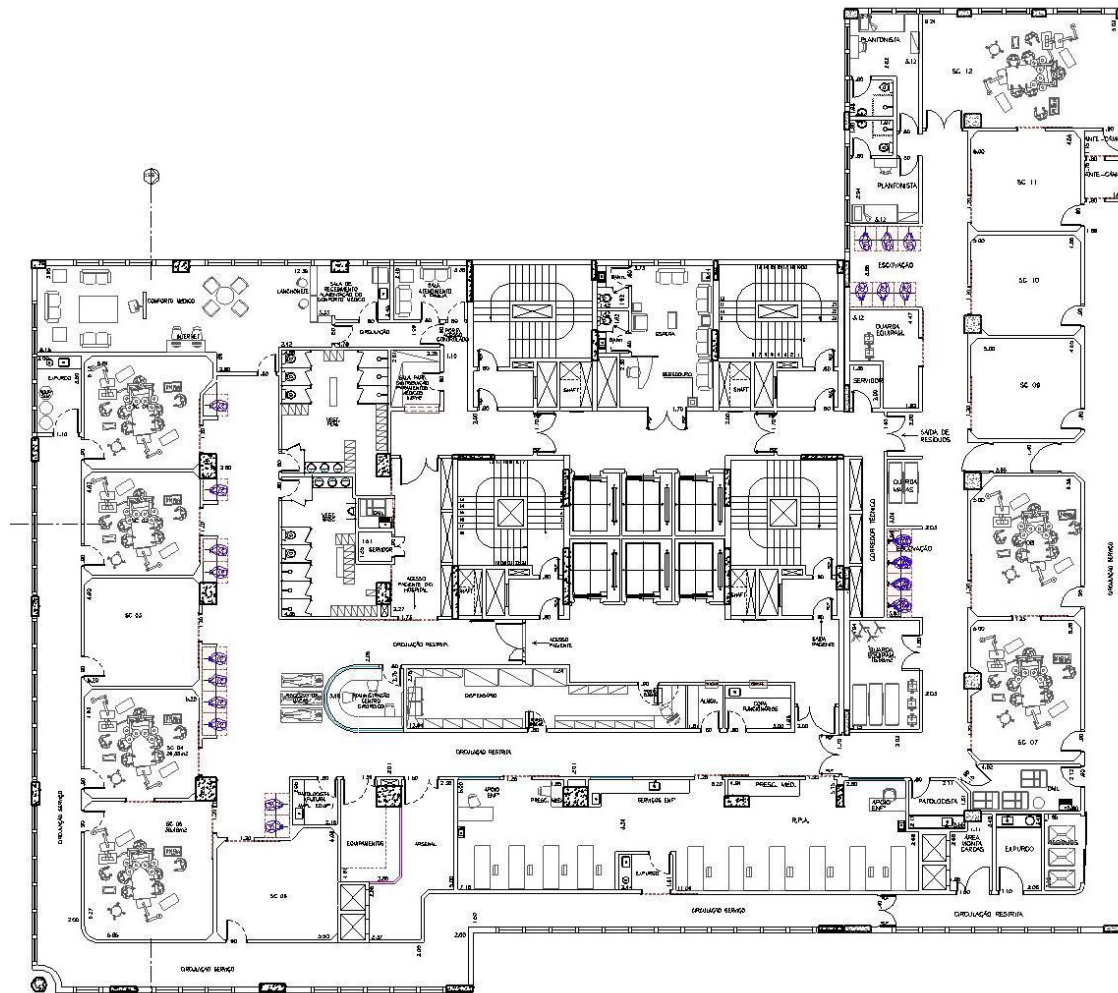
Planta Baixa Centro Cirúrgico – Corredor periférico
